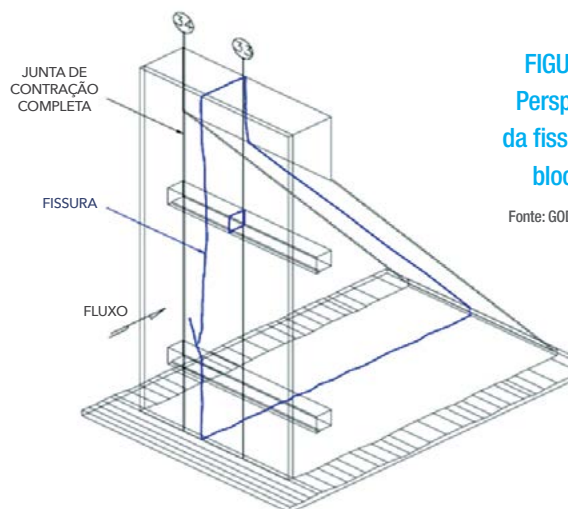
Perspectiva da fissura no bloco B11
